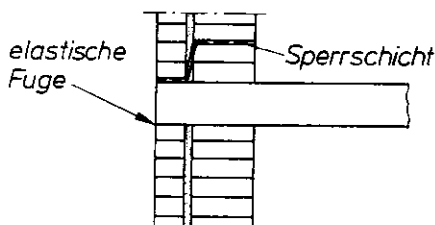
Sperrschrift über Abfangungskonstruktion der Außenschale bei zweischaligem Verblendmauerwerk ohne Luftschicht (Prinzipiskizze). Die Wärmedämmung der Decke ist zu beachten (z. B. Konstruktionsleichtbeton)
